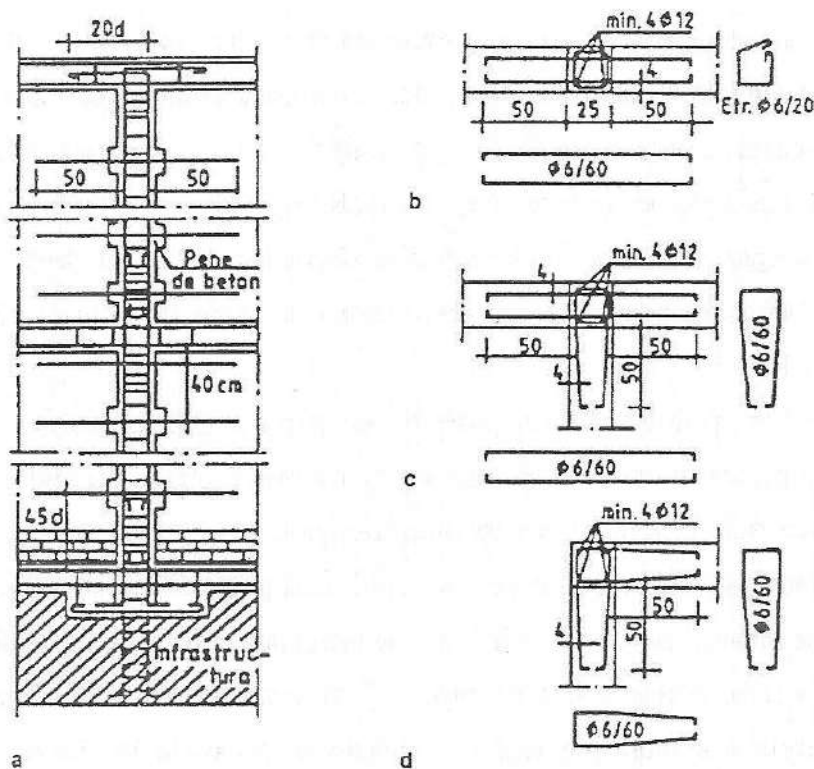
Stâlpișor de beton armat înglobat în zidărie;
